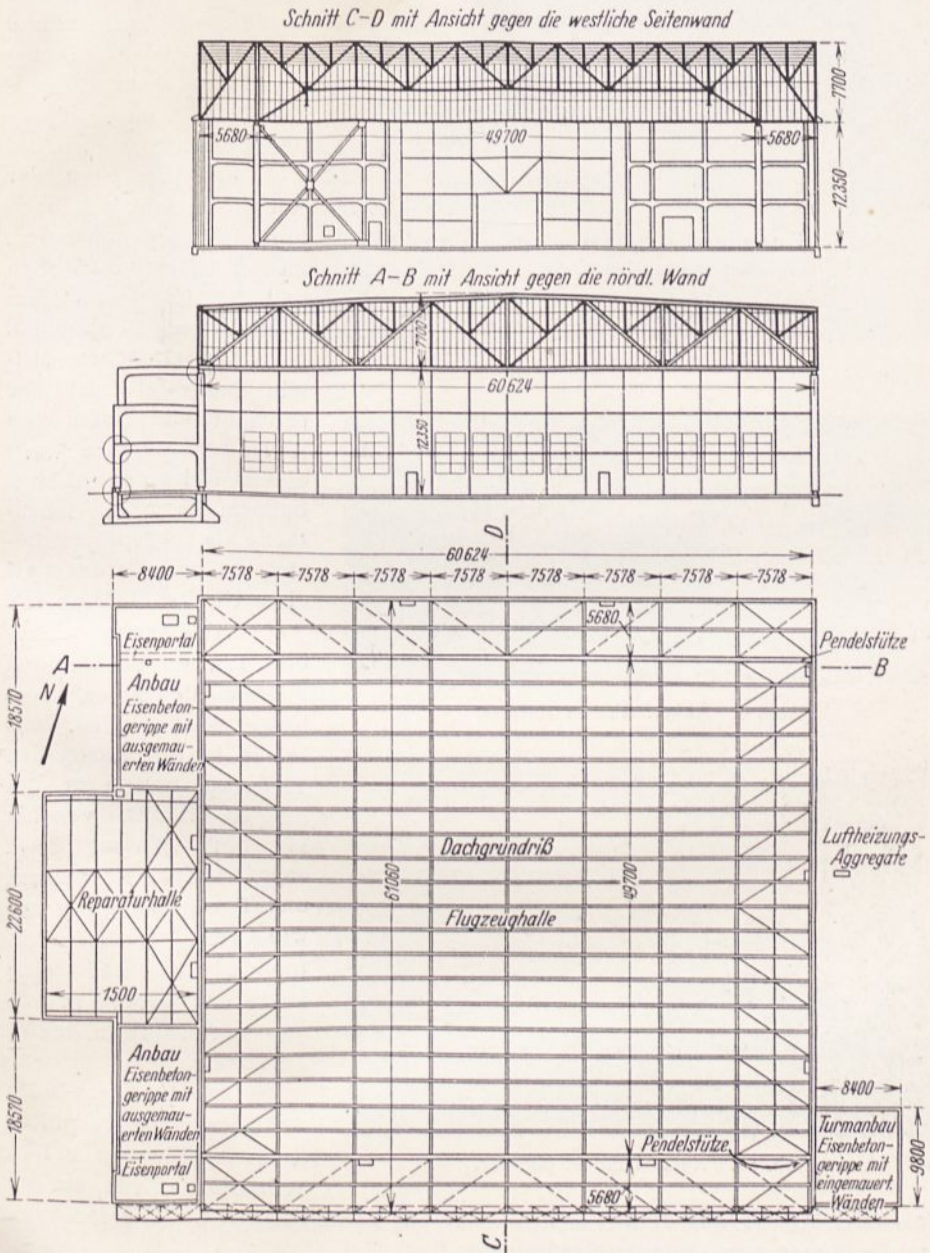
Grundriß und Schnitte der Flugzeughalle in Travemünde.
